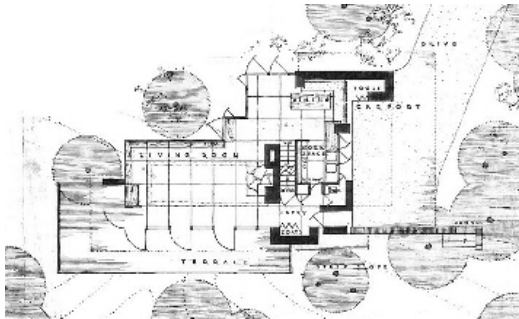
Planta baja, casa John C. Pew 1938, 3650 Lake Mendota Dr., Shorewood Hills
